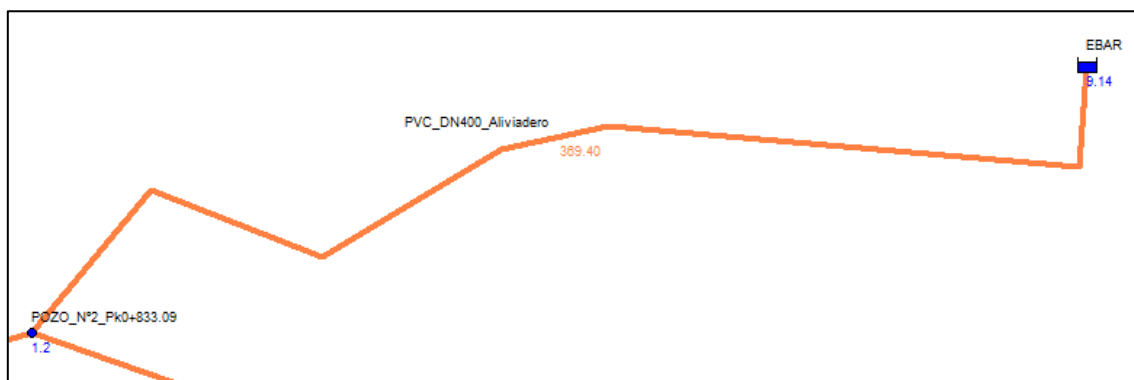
Tramo Aliviadero EBAR hasta Pozo Nº2
